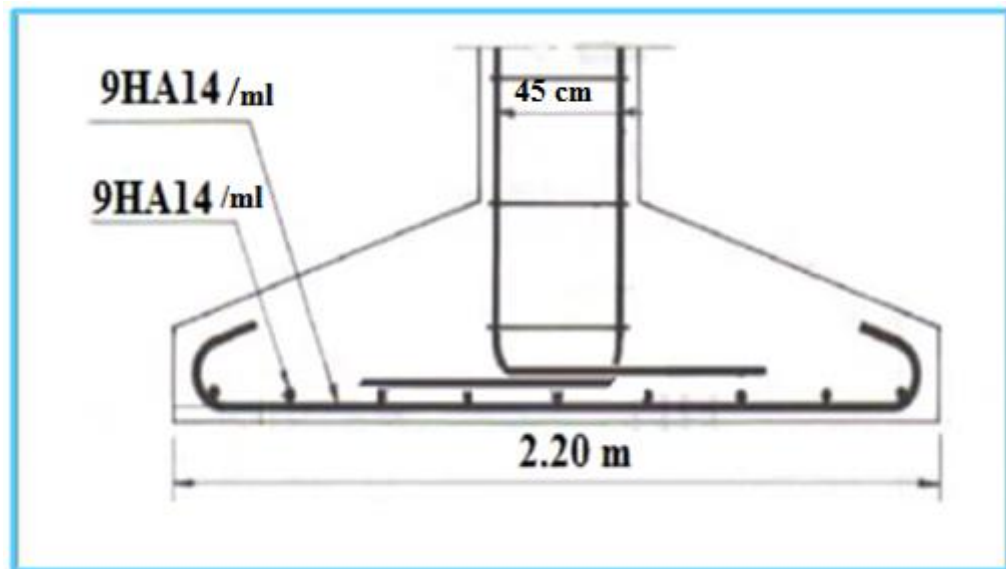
Ferrailage de la semelle isolée sous poteau (45*45).
